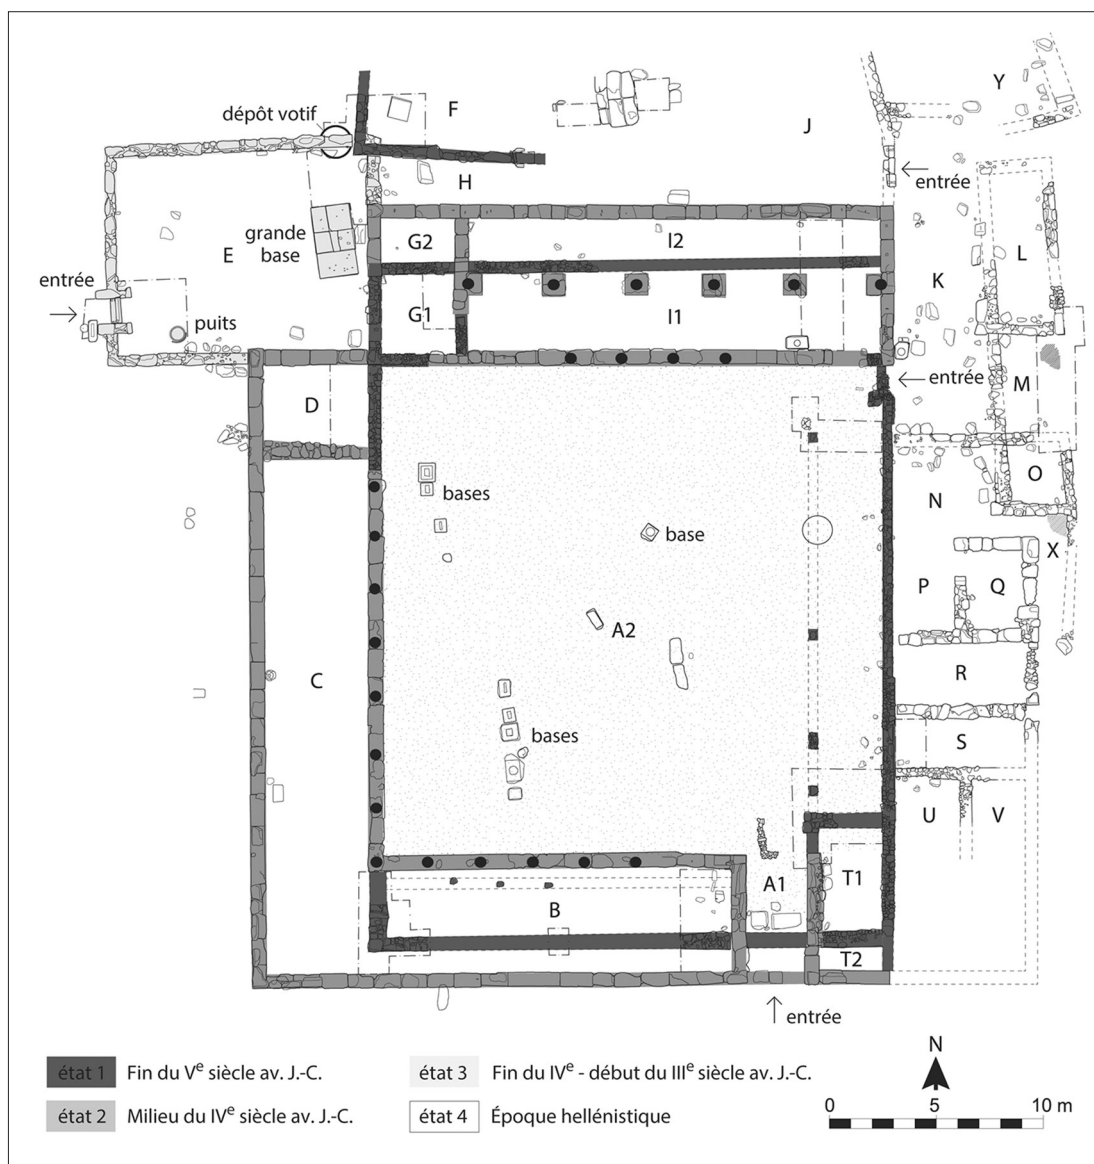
plan des différents états de construction de la palestra Sud d'Érétrie.
